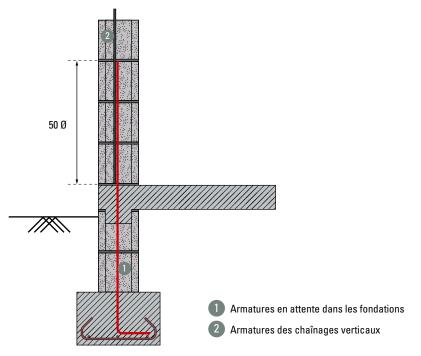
Exemple de liaisons entre armatures de fondations et chaînage vertical
